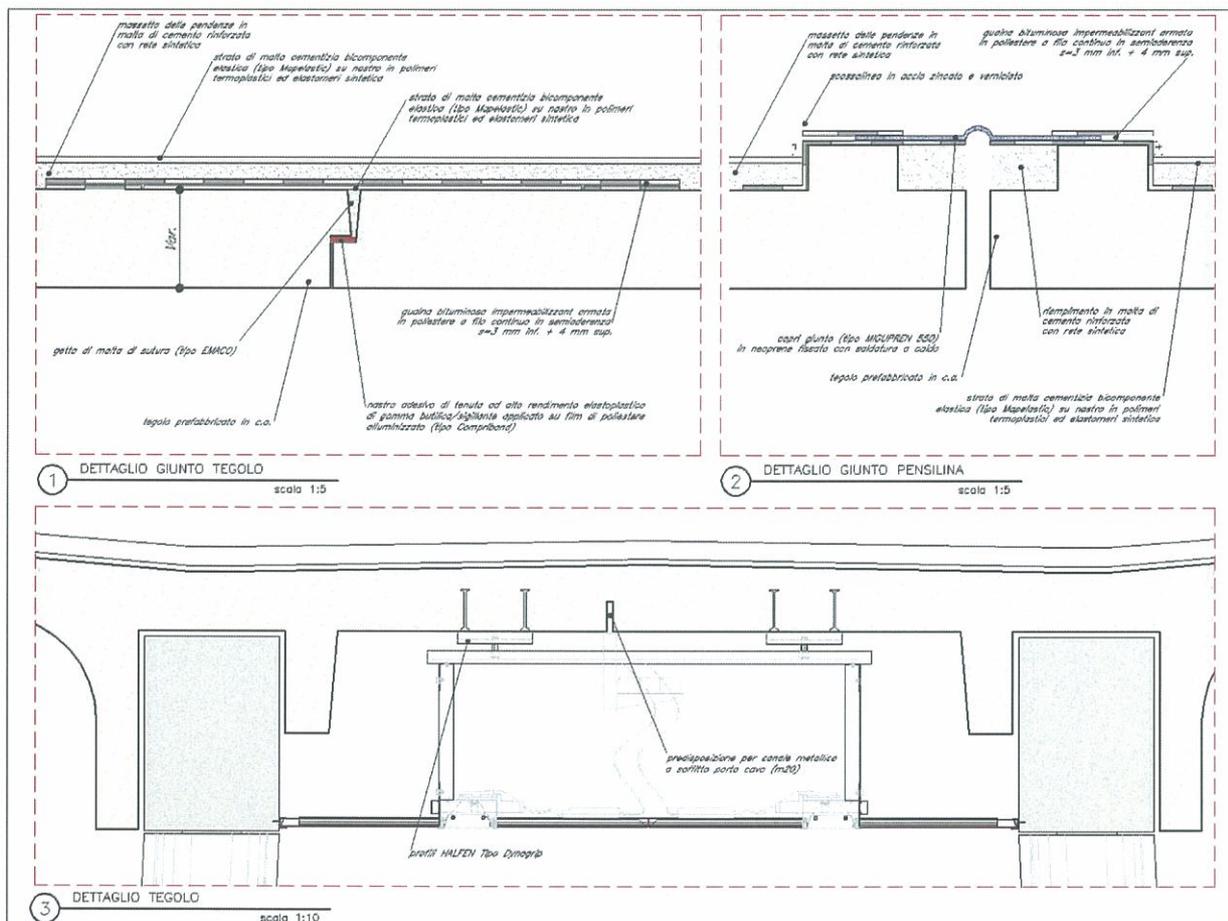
Pensilina prefabbricata in c.a. – dettagli tegoli
